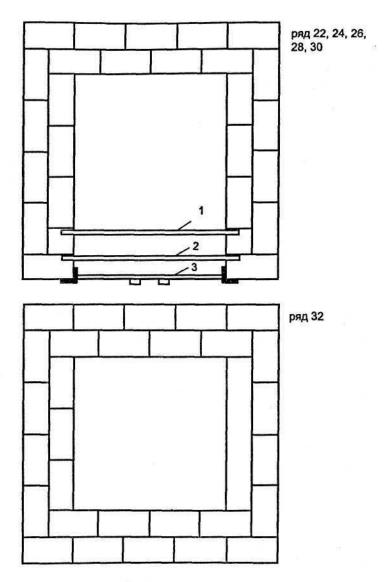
Схемы кладки печи — тандыра 1—3 — стальные уголки
